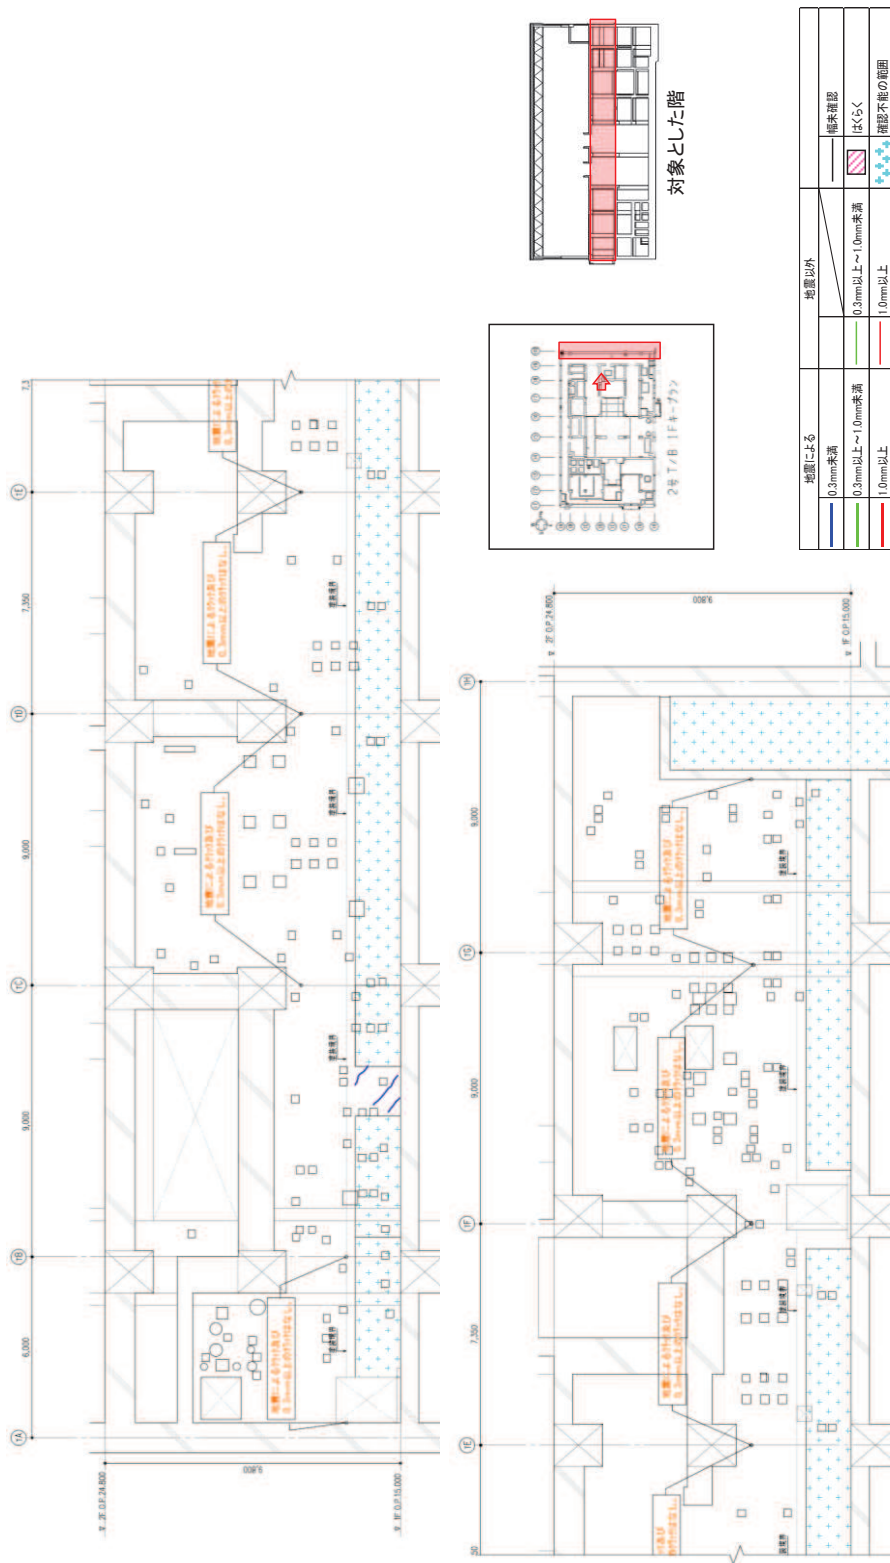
タービン建屋のひび割れ分布 耐震壁 (41) 1 階 T10 通り
